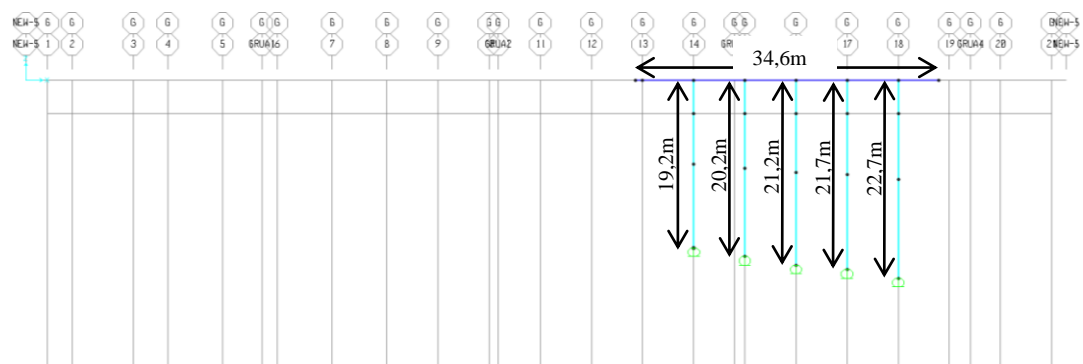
Vista en elevación del plano G de geometría, paralelo a plano X-Vertical'.
